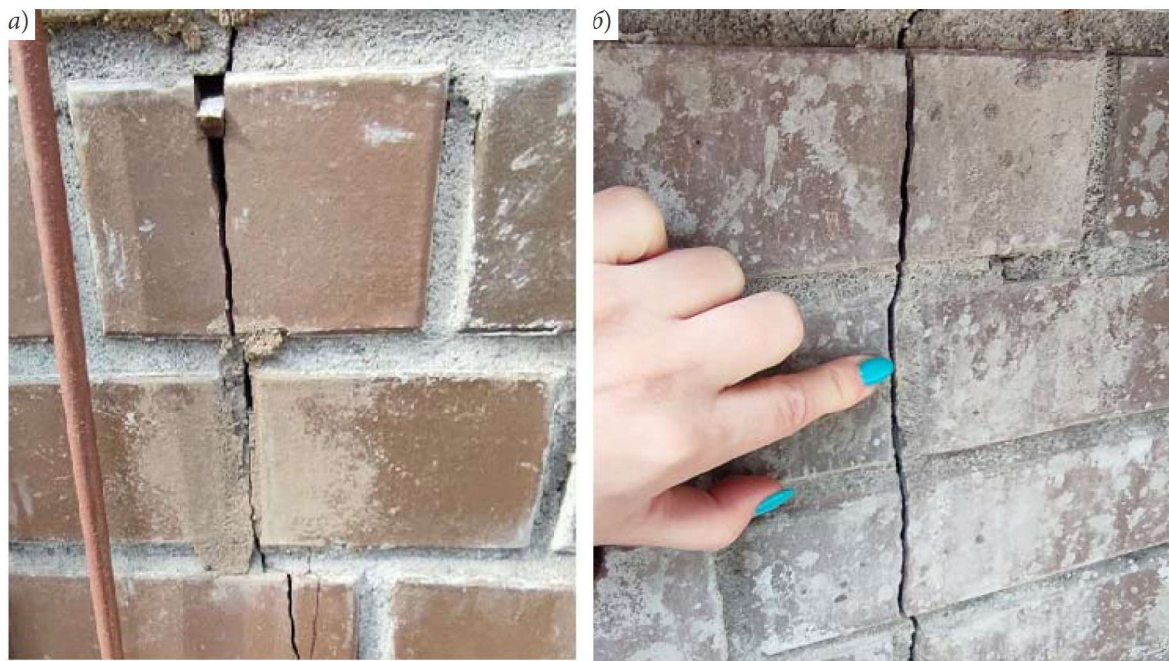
Трещины в кирпичной кладке стен: а — в центральной части дома с раскрытием до 9 мм; б — под балконами первого этажа с раскрытием до 5 мм
